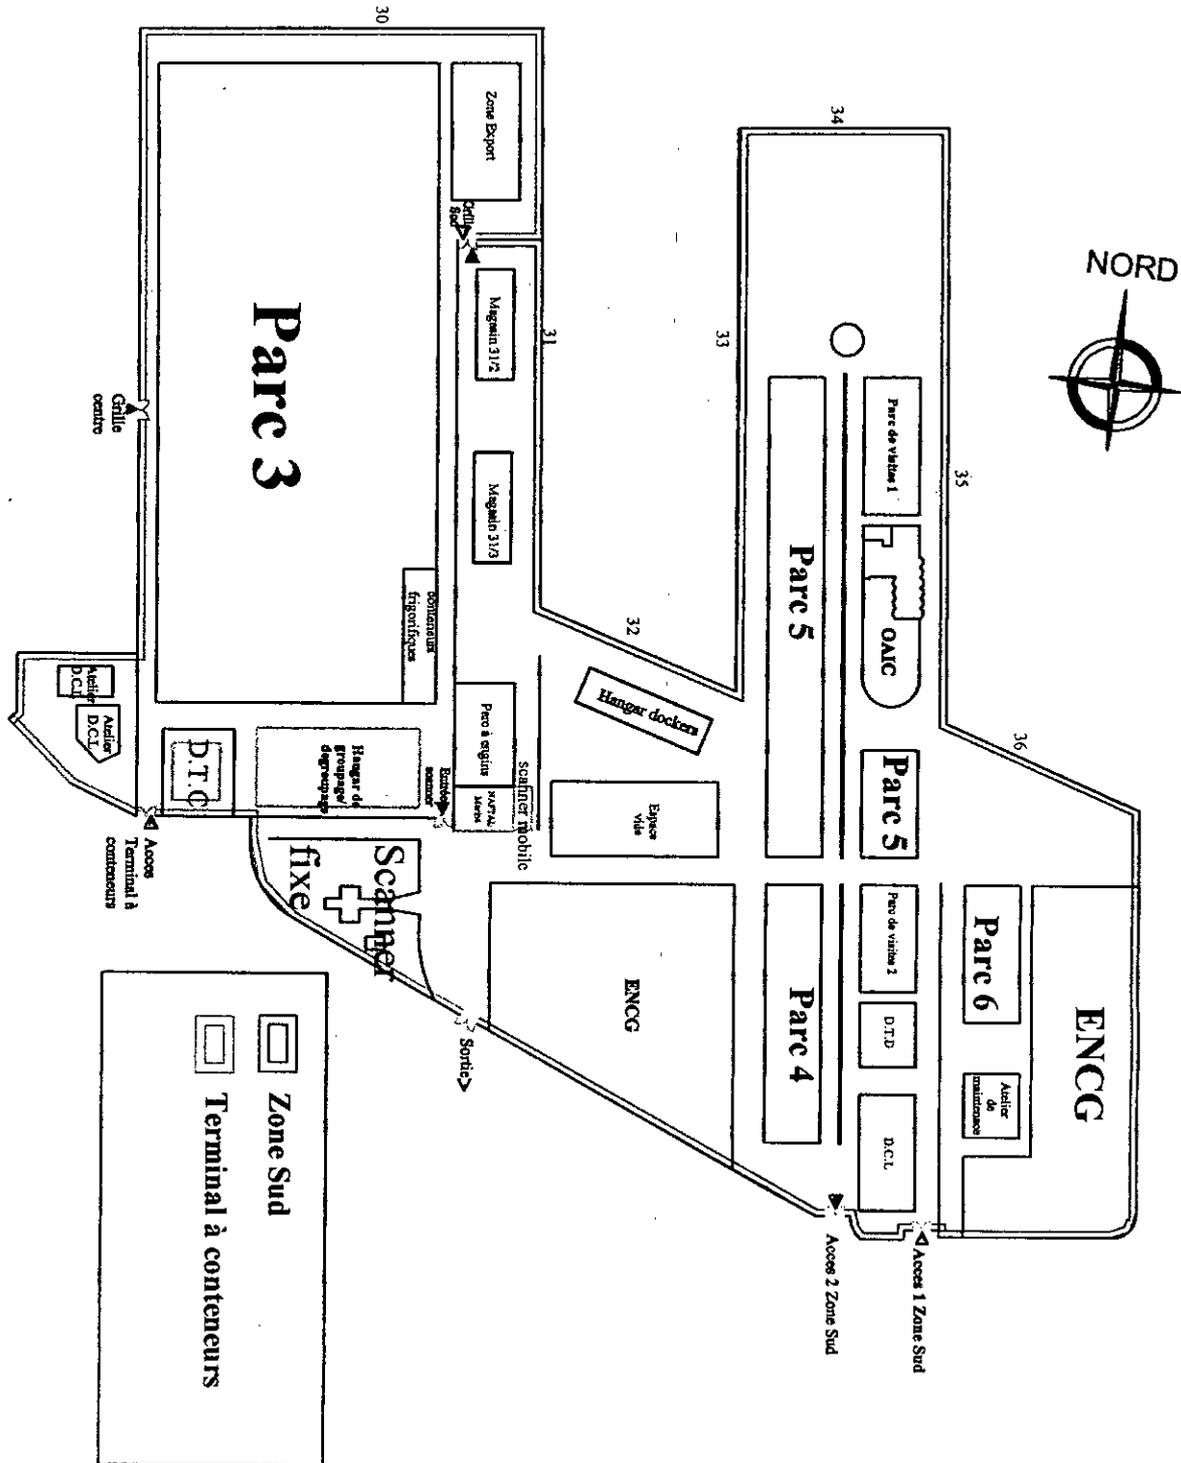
Plan de masse de la zone sud et du terminal à conteneurs.
